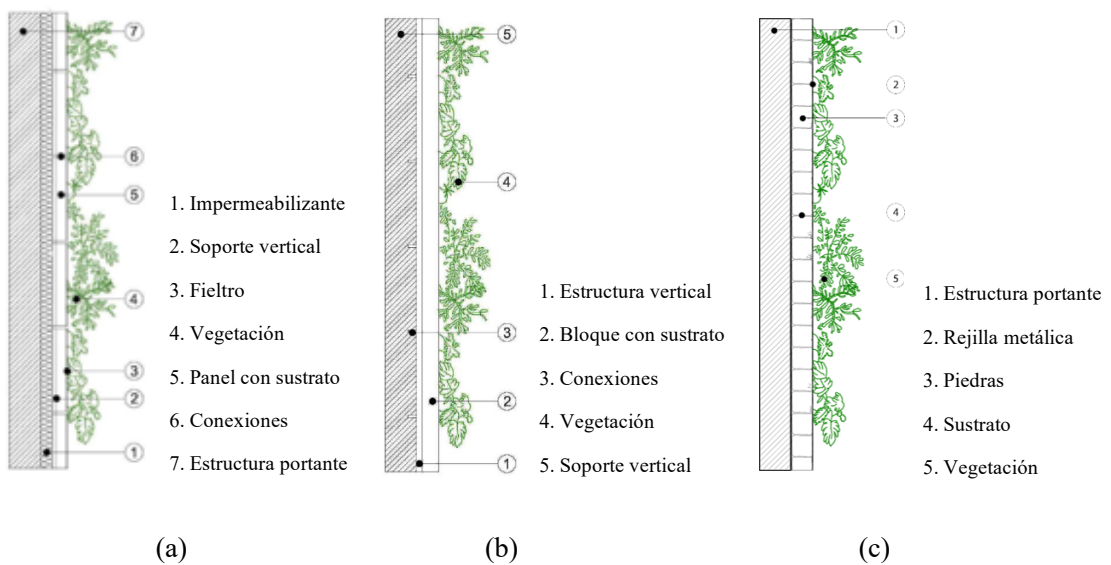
(a) Sistema modular de jardinería vertical de paneles (b) Sistema modular de jardinería vertical de bloques (c) Sistema modular de jardinería vertical de gaviones.
